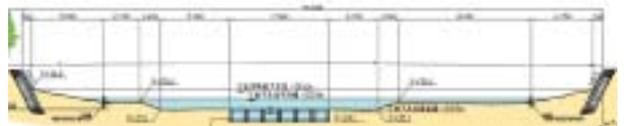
広瀬霞整備計画 横断面図（ボックス部 B-B断面）
